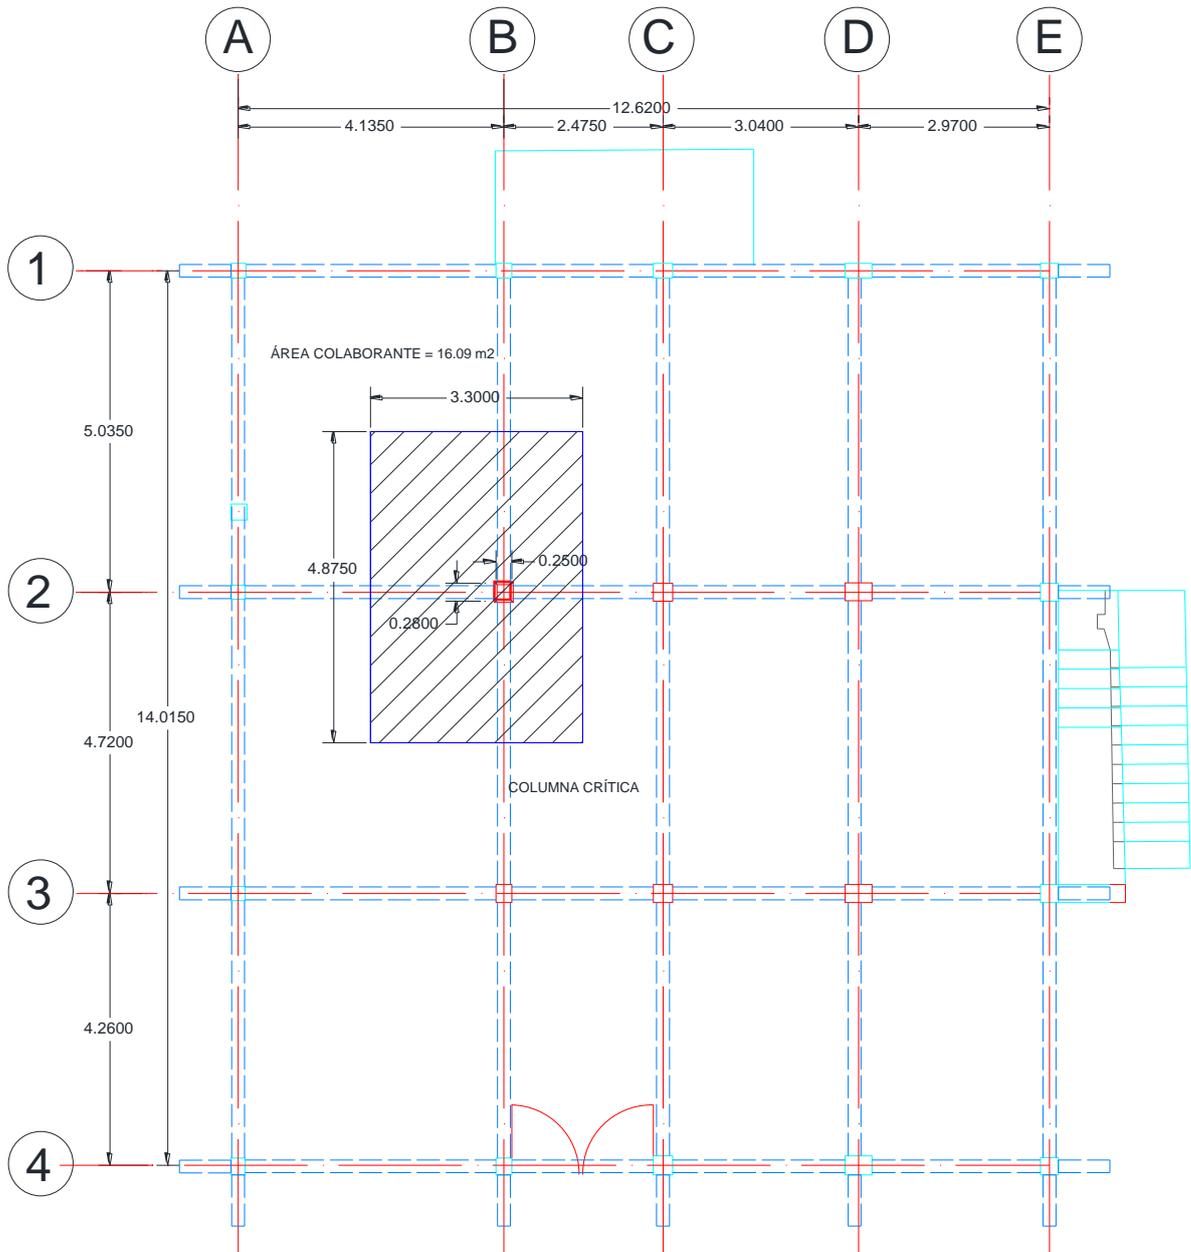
Vista estructural columnas en planta – plata baja – columna crítica
